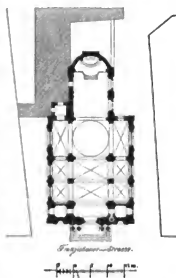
Bonn. Grundriss der St. Michaelskirche.
